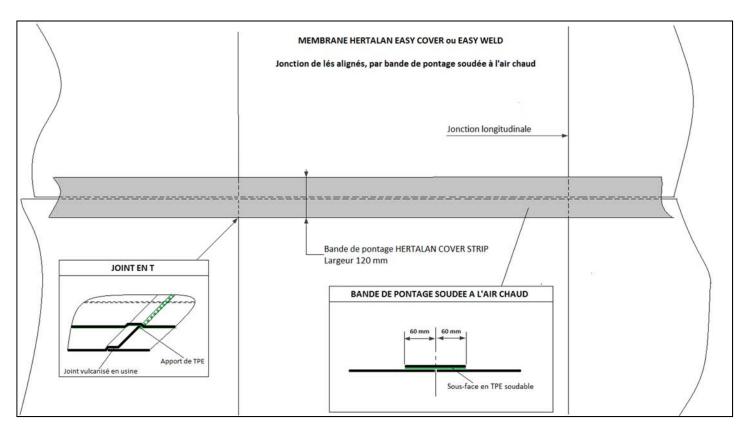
HERTALAN EASY WELD, joints alignés avec bande de pontage soudée
